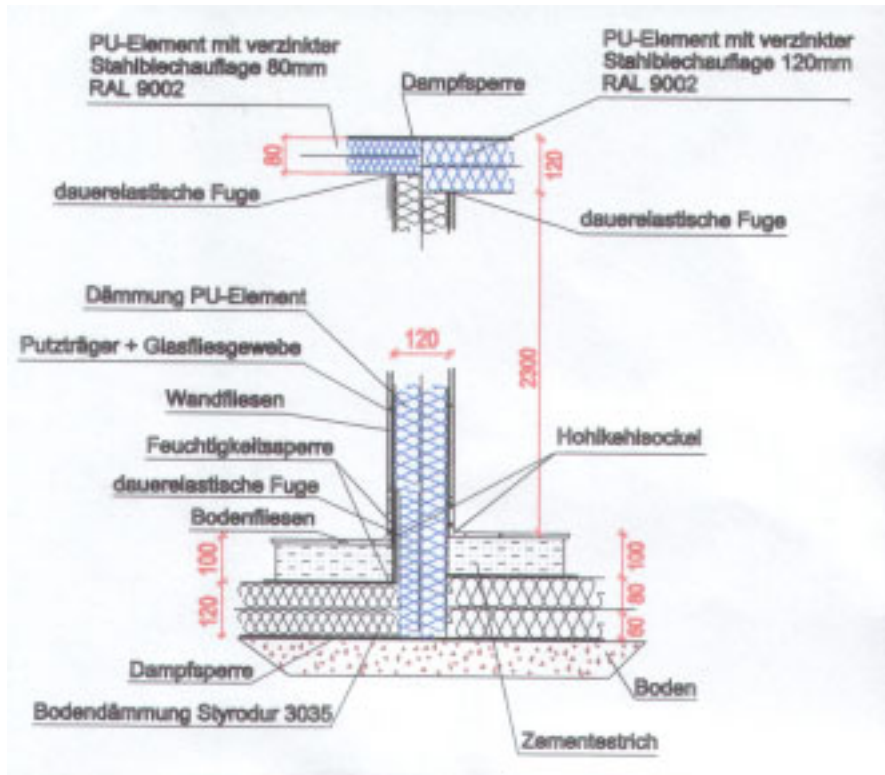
Schnitt Boden- Wandanschluss, Kühlzellentechnik
